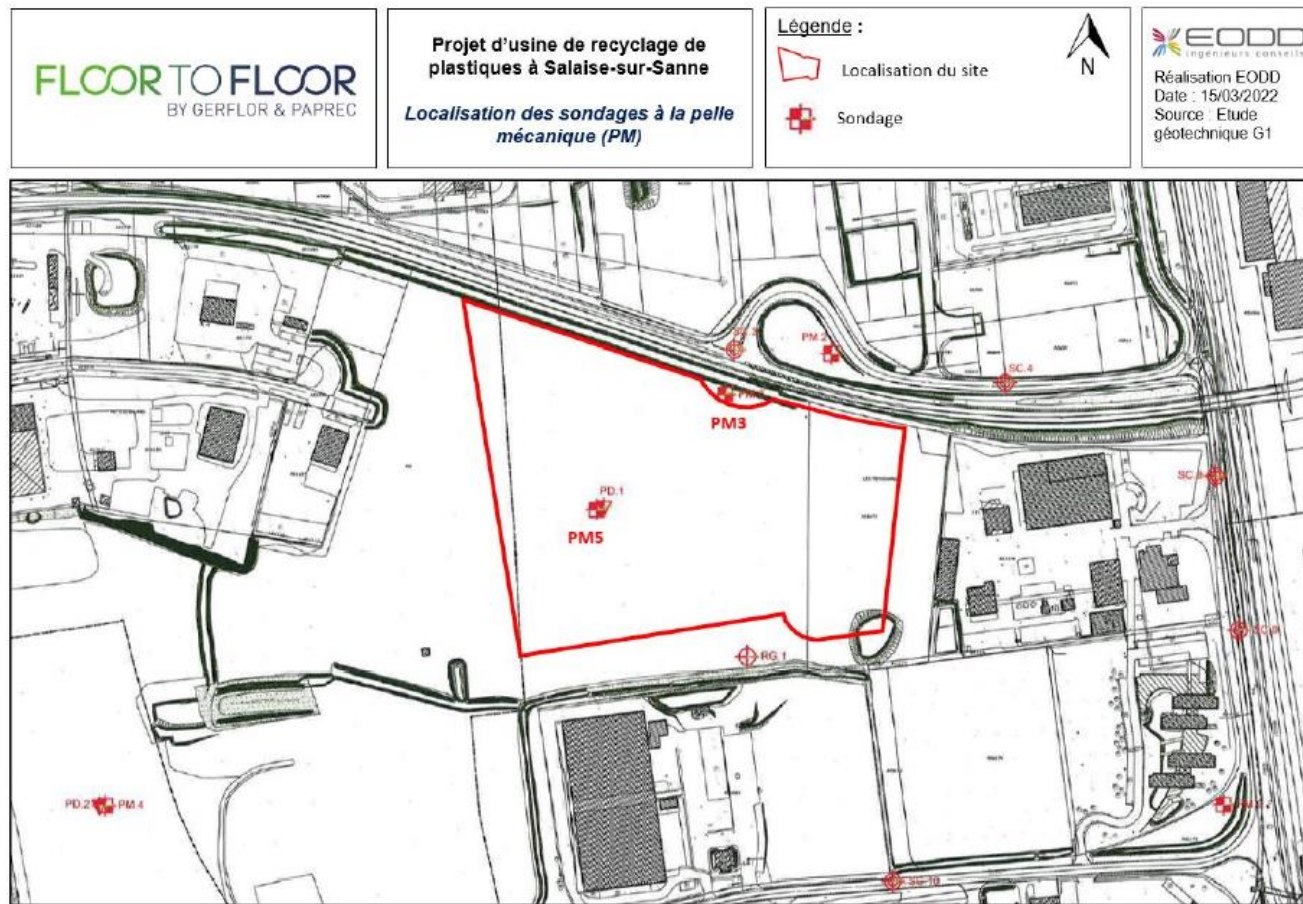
Localisation des sondages sur le lot B - Floor to Floor
